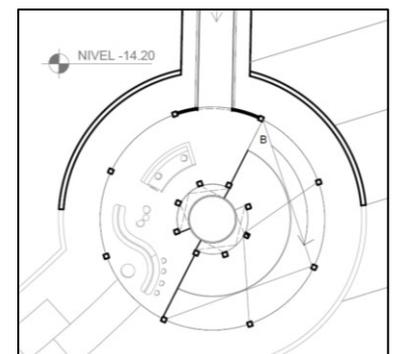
Planta alta de cilindro de talleres N-14.20. Elaboración propia.
